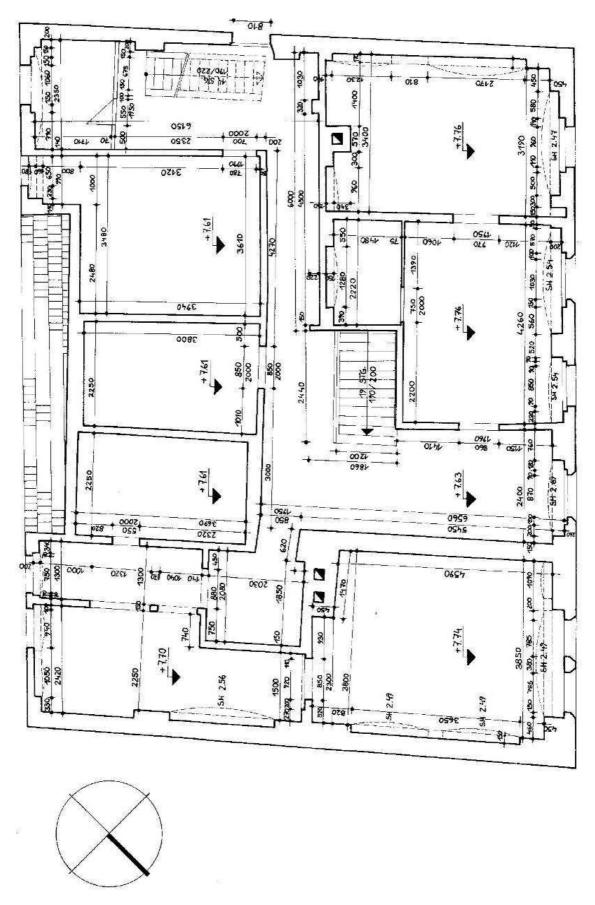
Webergasse 1, Grundriss des 2. Obergeschosses vor der Sanierung
